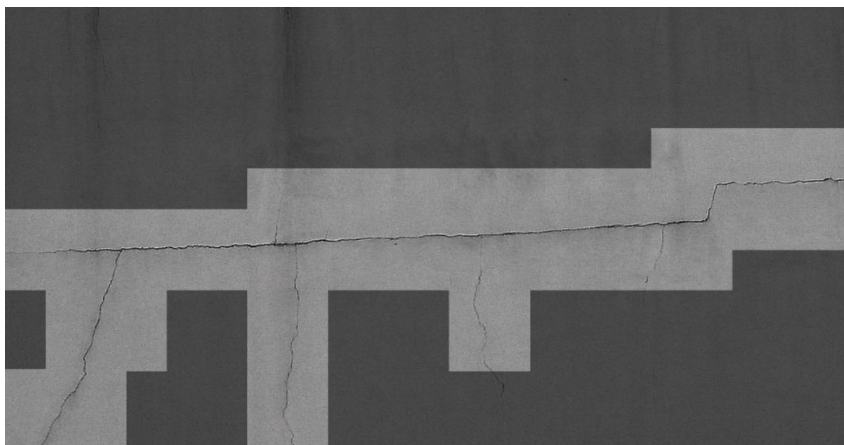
Detecção Fissura Z.F.04
